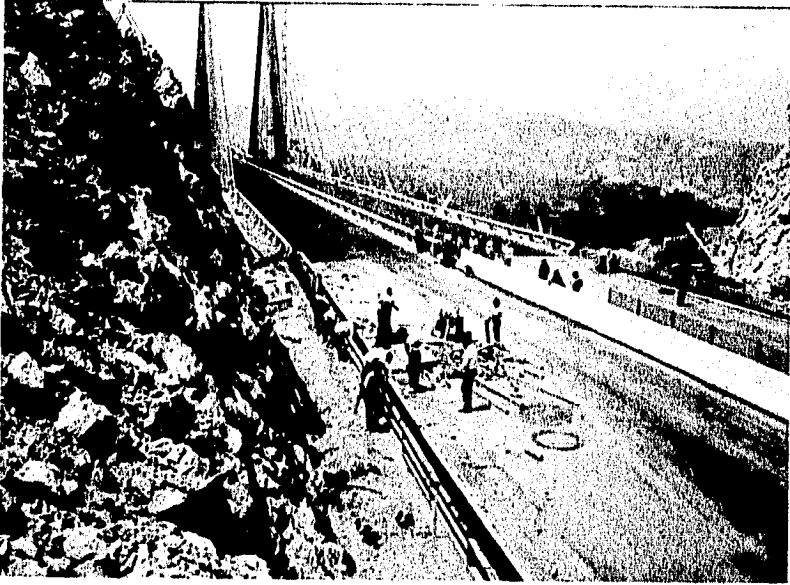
Vista general de cimbrado y armado de guarniciones, laterales y centrales. Y colocación de parapetos.
